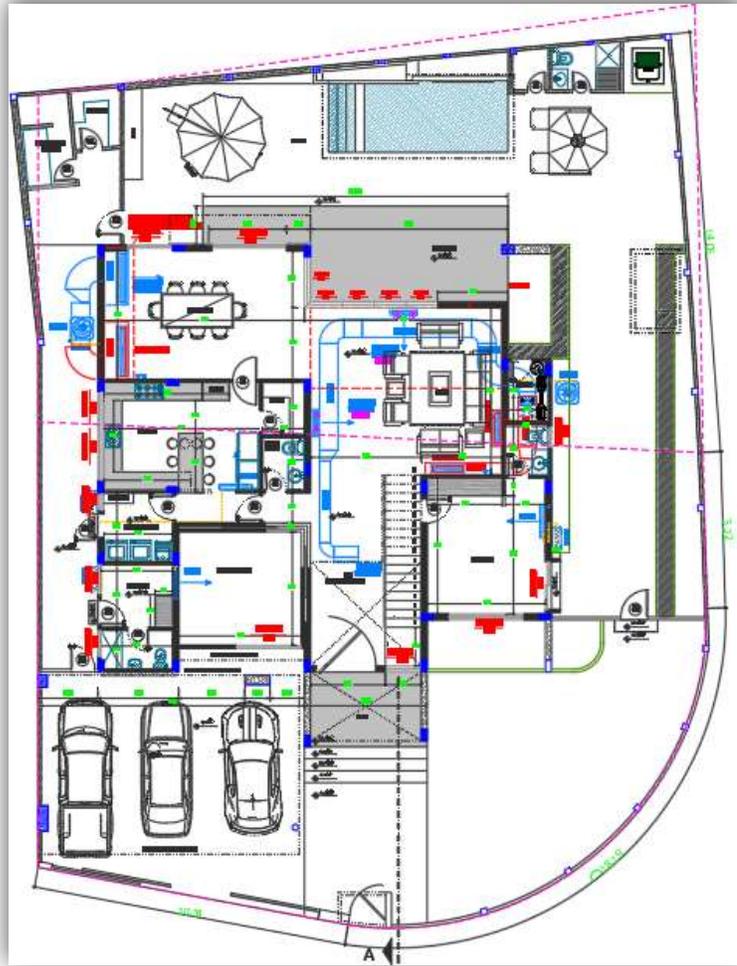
Dimensiones del terreno, Vista en planta Residencia Familiar, Planta Baja
